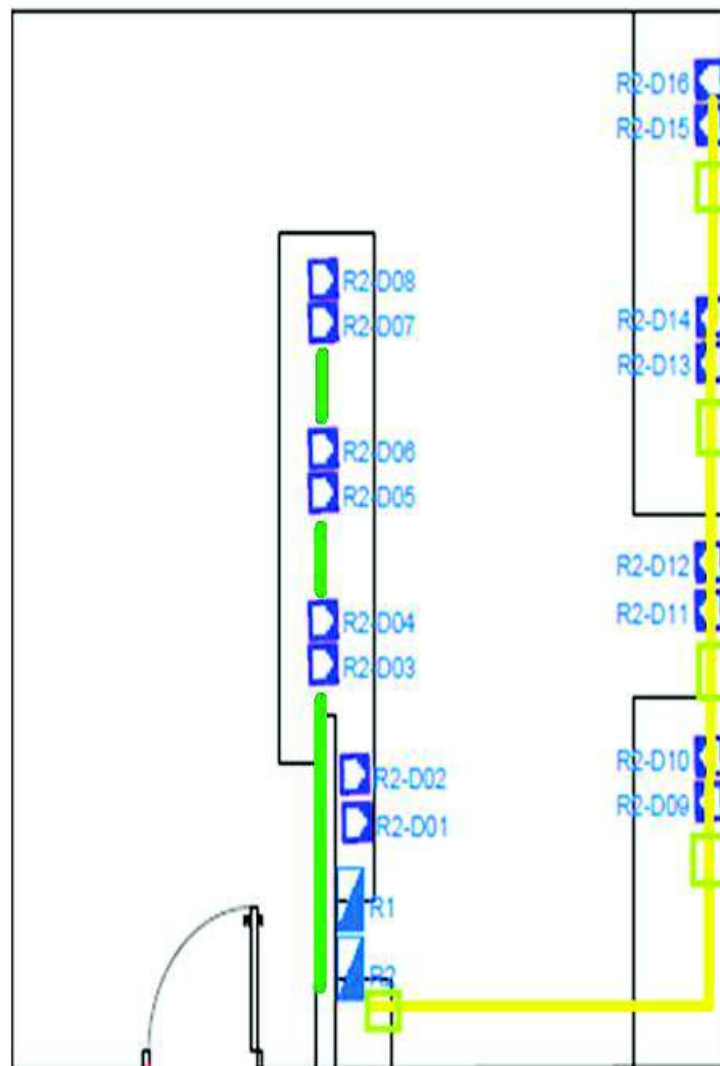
Diseño de rutas para el cableado horizontal (Fuente Propia)
